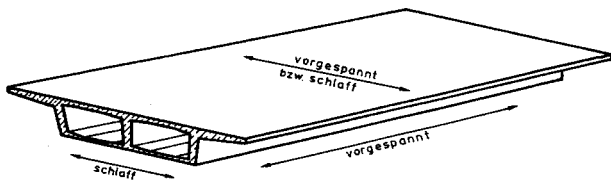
Übliche Kombinationen von Stahl- und Spannbeton-
